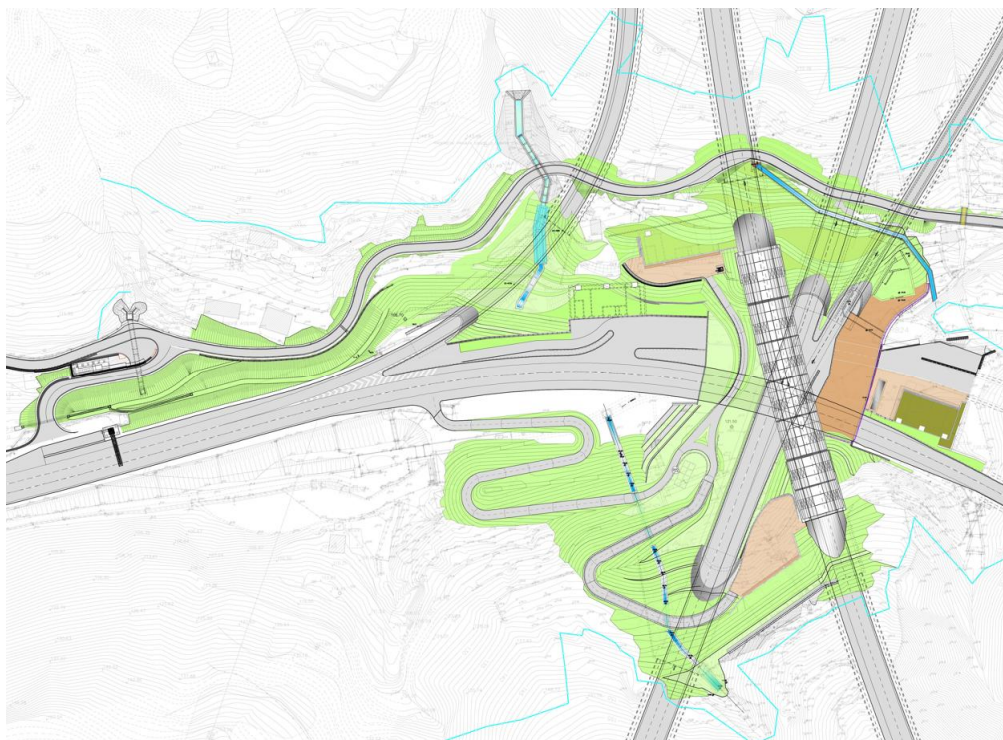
Planimetria delle sistemazioni finali dell'ambito Torbella
